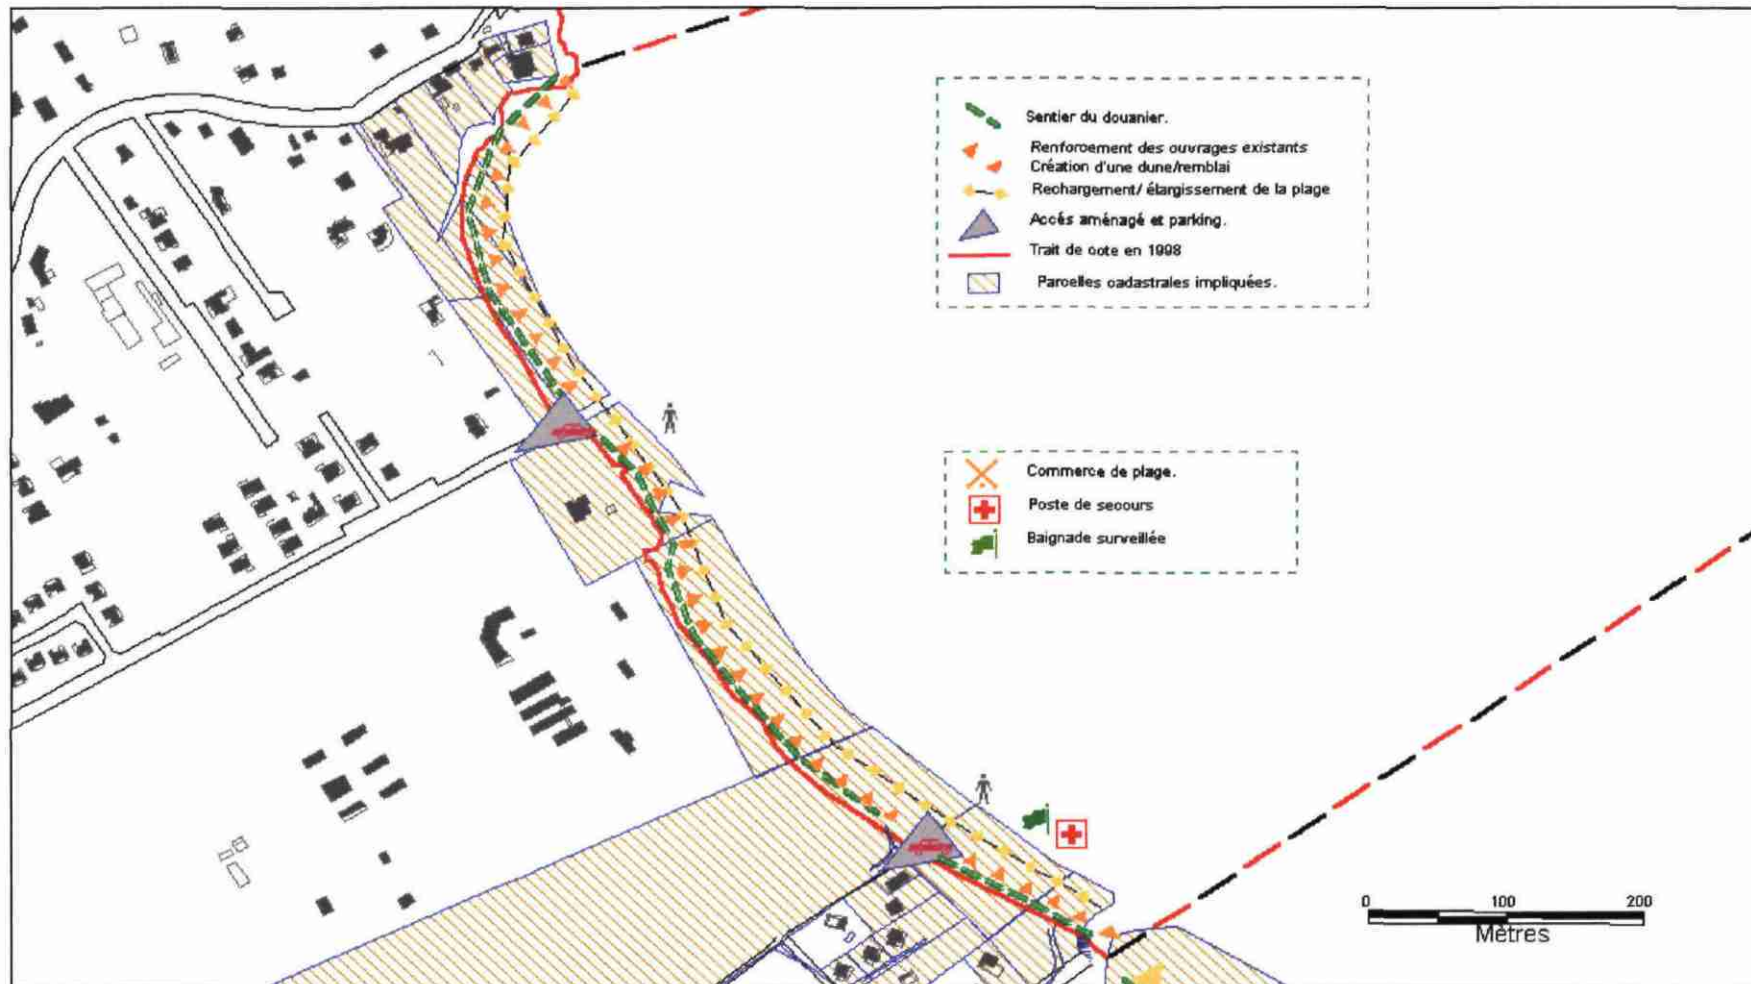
Proposition d'aménagement du secteur Constant Chlore sur la base de la restauration du trait de côte à son niveau de 1998.
